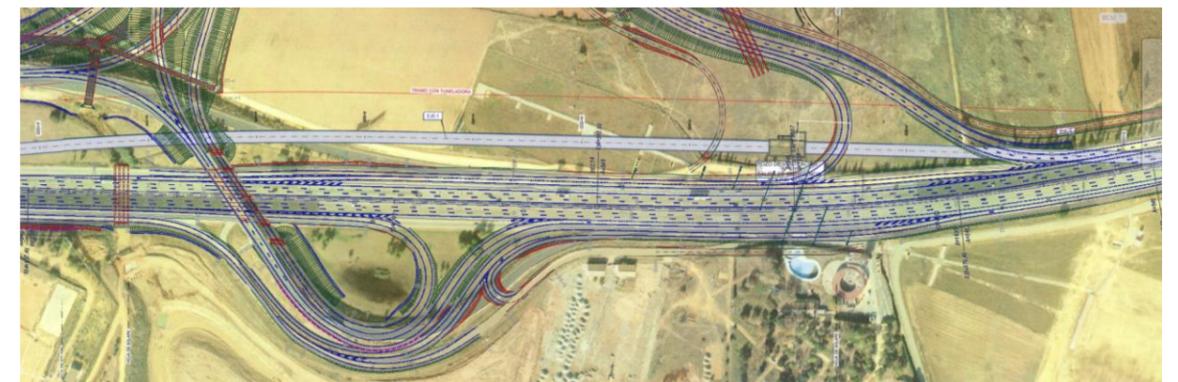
Montaje de planta del Proyecto del Eje ferroviario transversal de Andalucía y del presente proyecto
